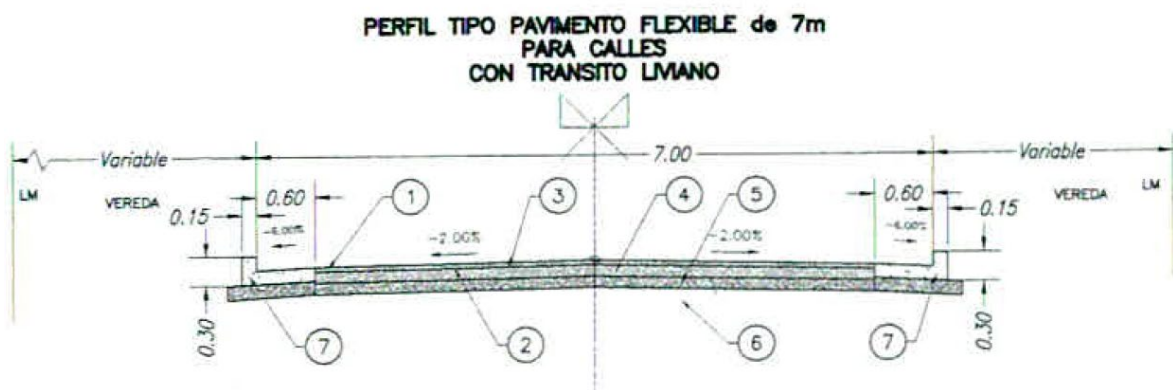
Perfil tipo Pavimento Flexible. – Fuente: Pliego técnico.
